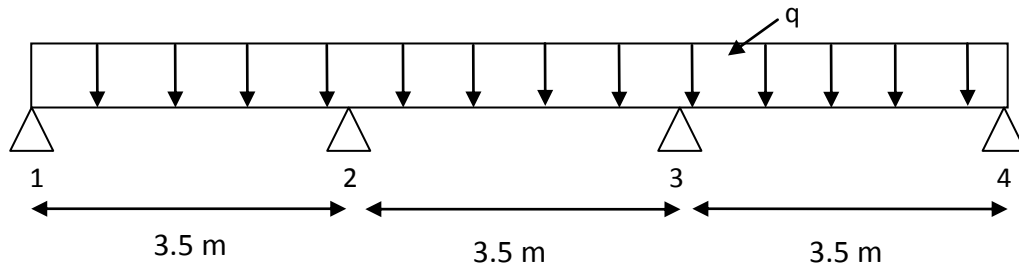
Schéma statique de la poutrelle (hyperstatique)
